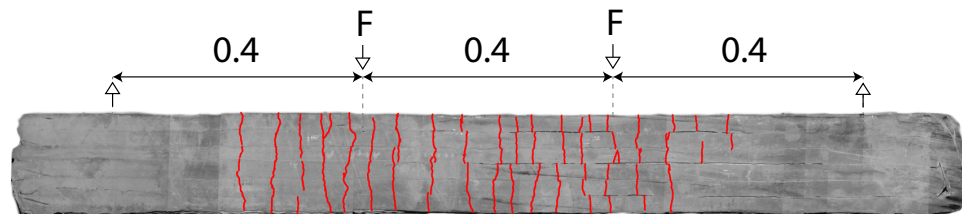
Fissures en sous-face de la poutre.
